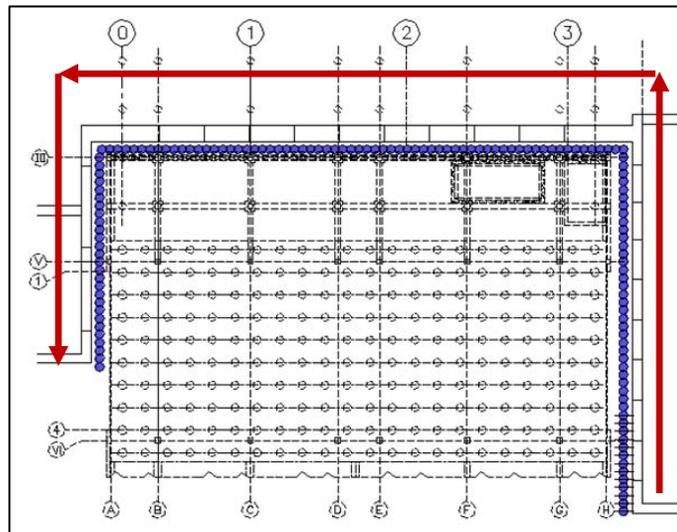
Planta de Inyecciones de jet-grouting.
